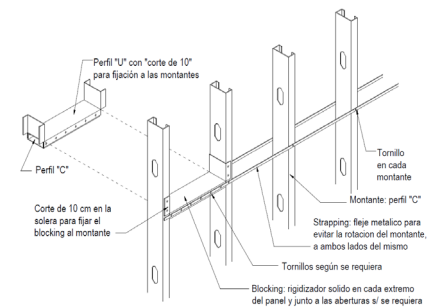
Rigidizador tipo para los dos tipos de paneles.
